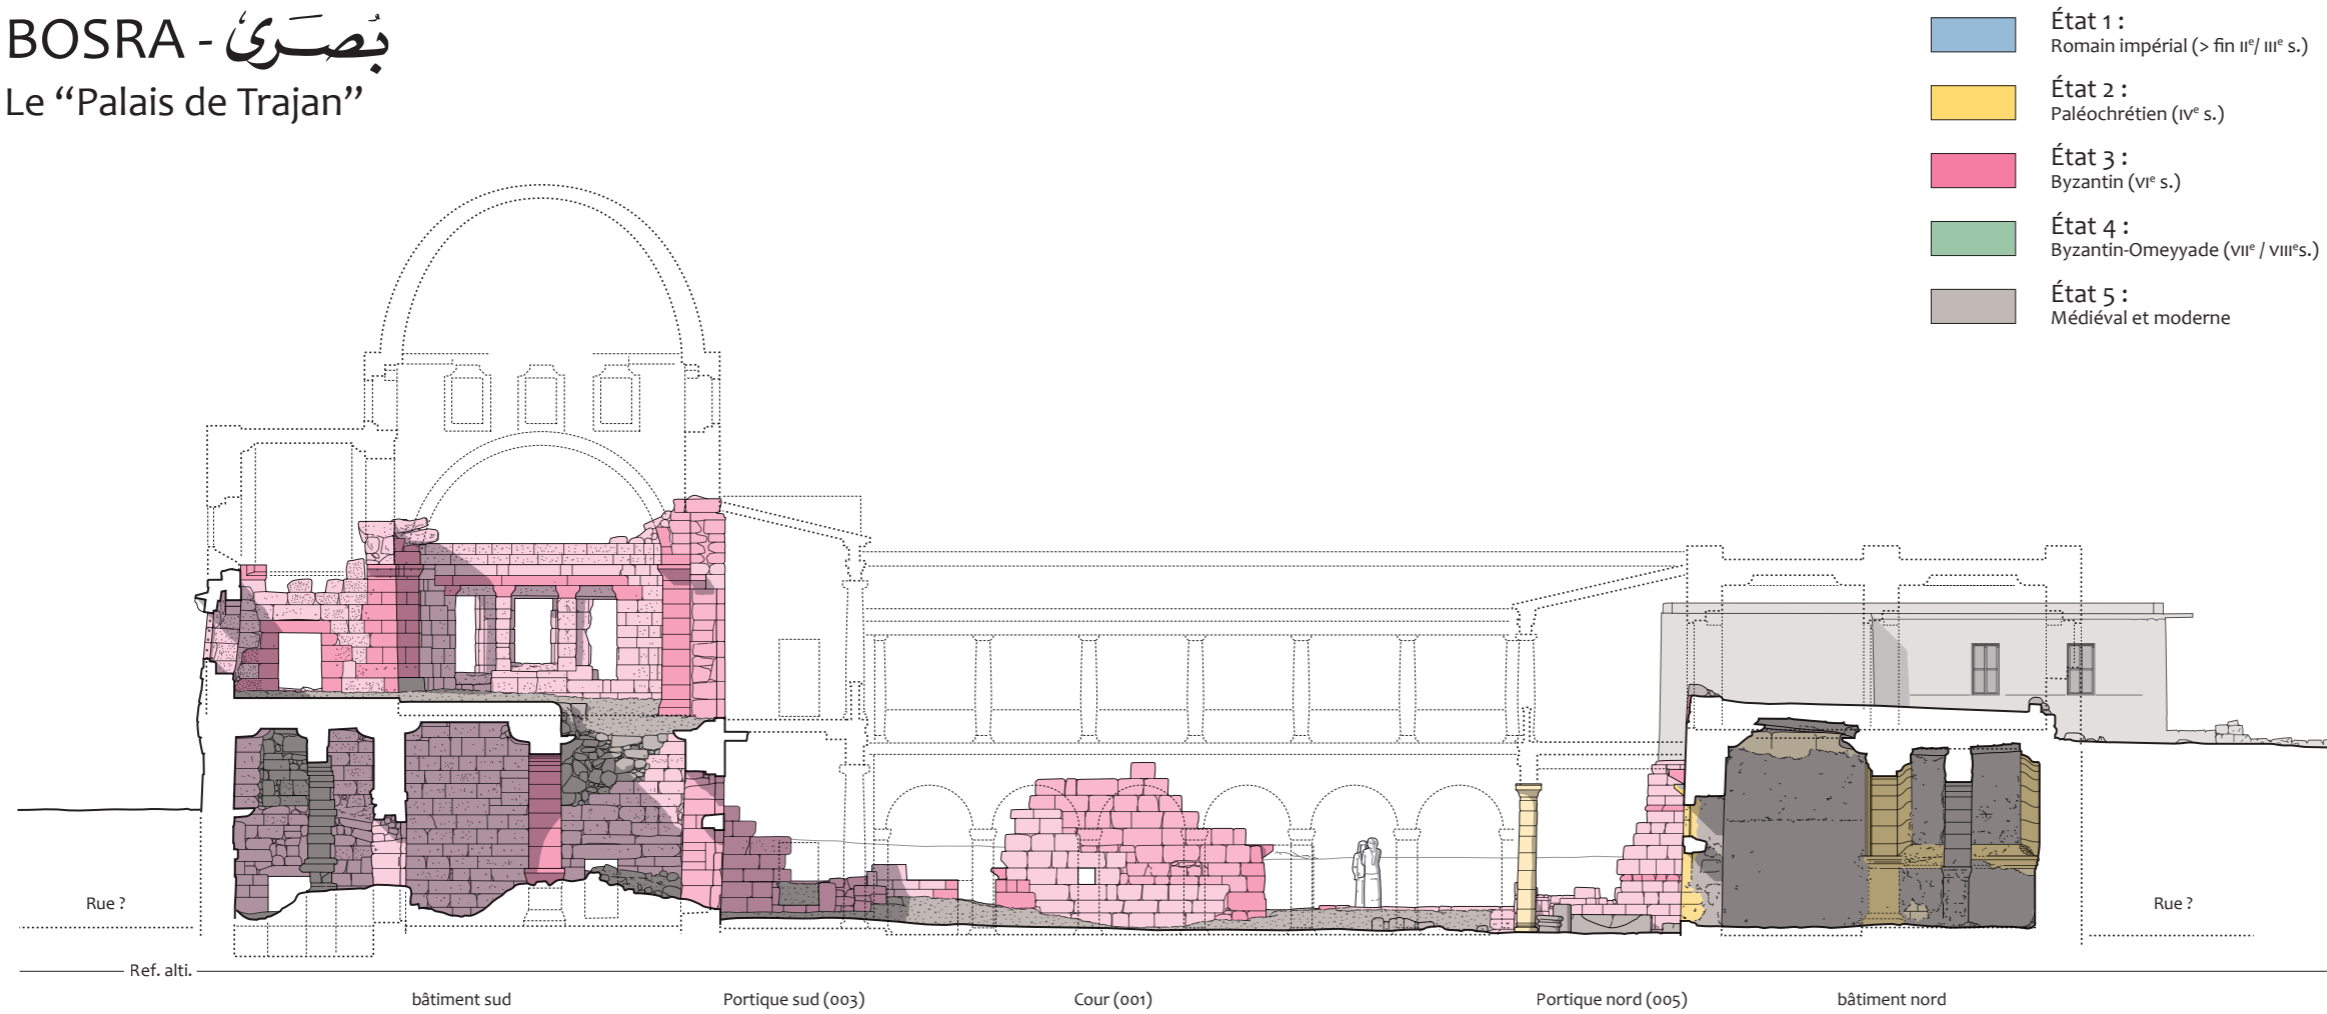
Le «Palais de Trajan», coupe 3, coupe-élévation nord-sud (vue vers l'ouest) sur la salle à alcôve et la salle triconque. Étapes de construction et chronologie
